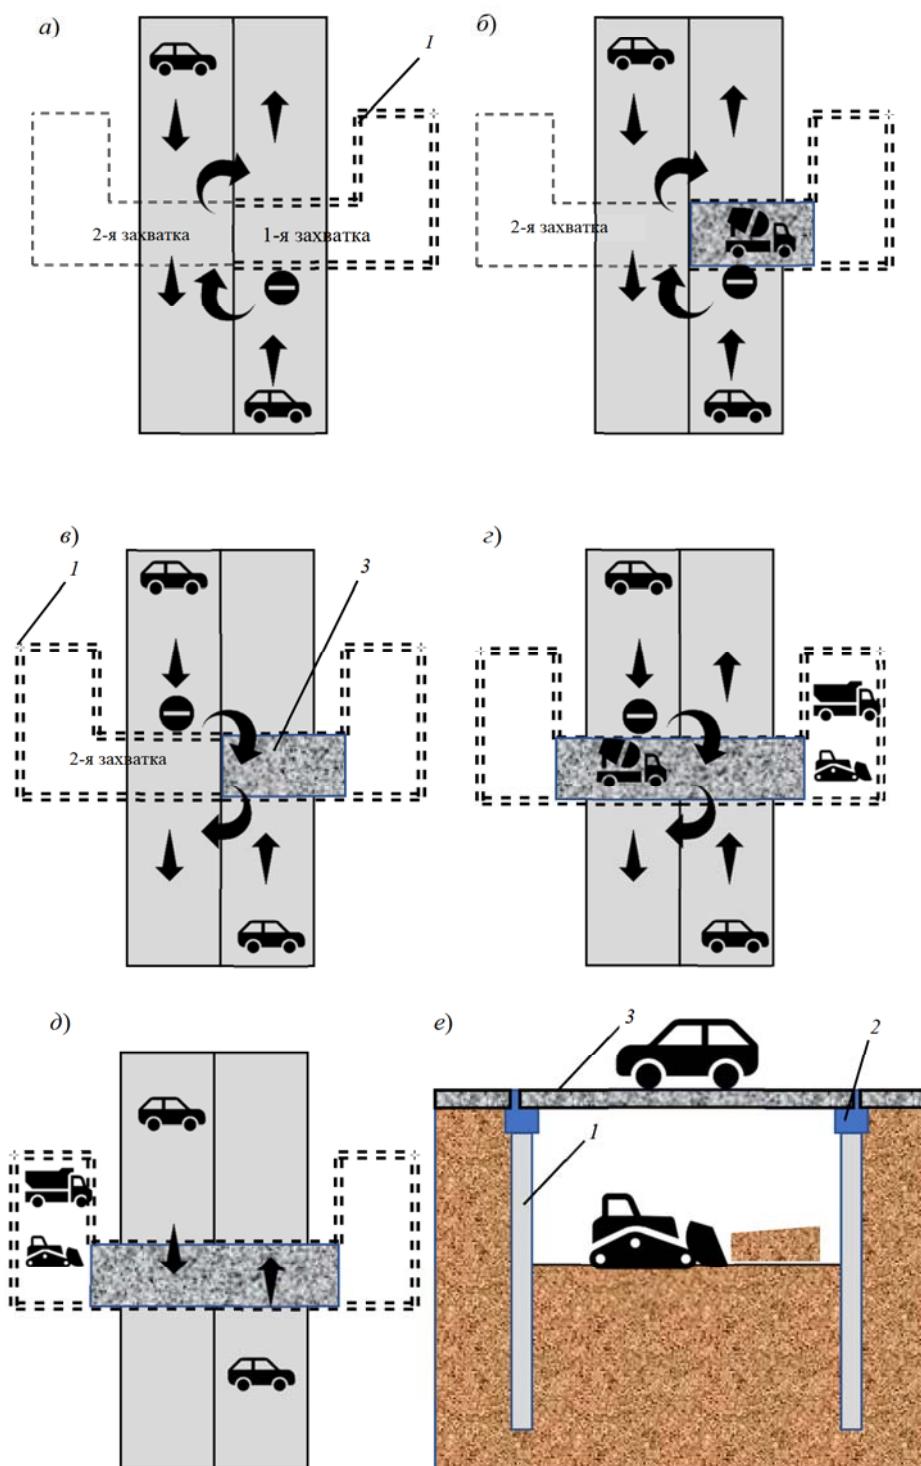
Технологический план-схема устройства ППТ с применением шпунта в качестве ограждающих конструкций: а — погружение шпунта на 1-й захватке; б — производство земляных работ, формирование опорного узла и устройство монолитной армированной плиты покрытия на 1-й захватке; в — погружение шпунта на 2-й захватке; г — производство земляных работ, формирование опорного узла и устройство монолитной армированной плиты покрытия на 2-й захватке. После набора проектной прочности бетона возобновляют движение автотранспорта по проезжей части. Разработка и вывоз грунта из контура ограждения 1-й захватки; д — разработка и вывоз грунта из контура ограждения 2-й захватки. Устройство основания ППТ и отделка стен тоннеля; е — поперечный разрез тоннеля на этапе разработки грунта под плитой дорожного покрытия: 1 — шпунтовое ограждение; 2 — балки опирания плиты по торцу шпунта; 3 — монолитная плита
